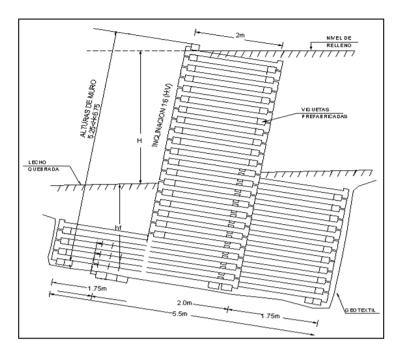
Muro de Viguetas Prefabricadas Corte A-A Fuente: J. Lema
